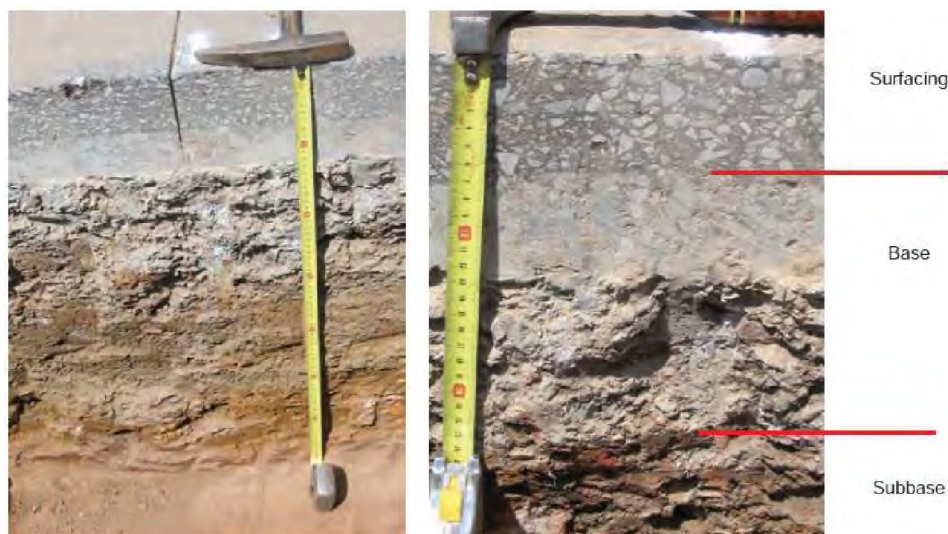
Příklad kopané sondy v konstrukci vozovky[49]
